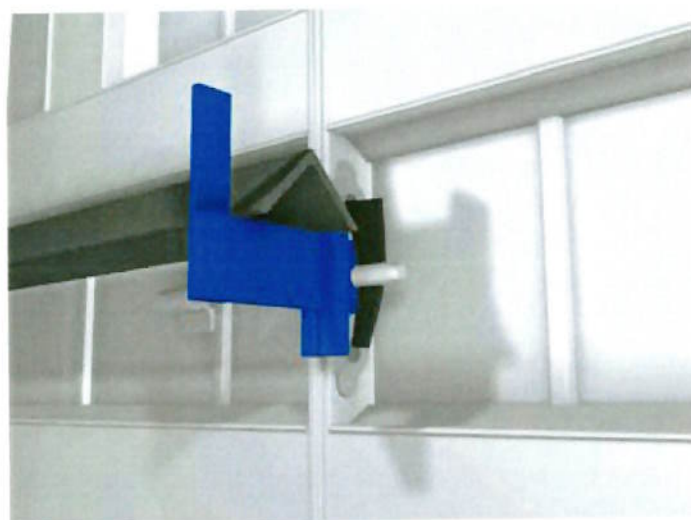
Montagem do Suporte para a Haste do Guarda Corpo (fonte: catálogo técnico FORSA)
